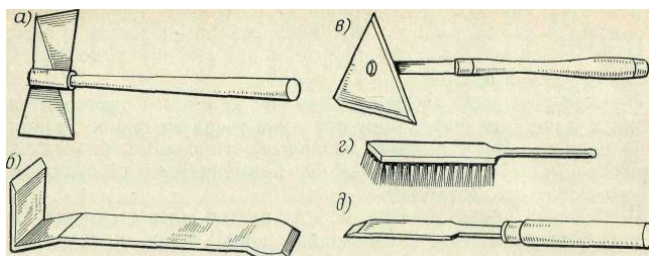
Ручные инструменты для очистки и подготовки поверхностей к окраске: а – кирка; б – скрябка двусторонняя; в – скрябка односторонняя с деревянной ручкой; г – стальная щетка; д – стамеска
